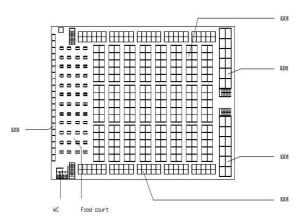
Denah Pasar Galuh Luragung Lantai 1
